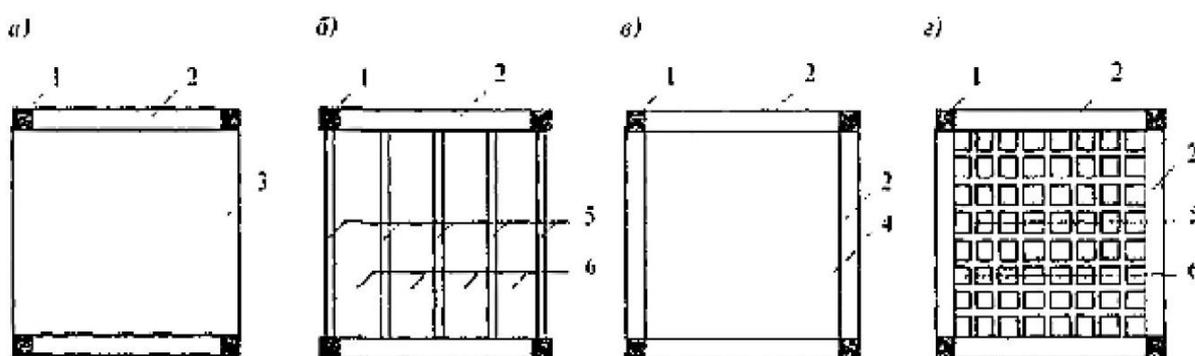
Плиты перекрытия в колонных КС с балками и в стеновых КС:
